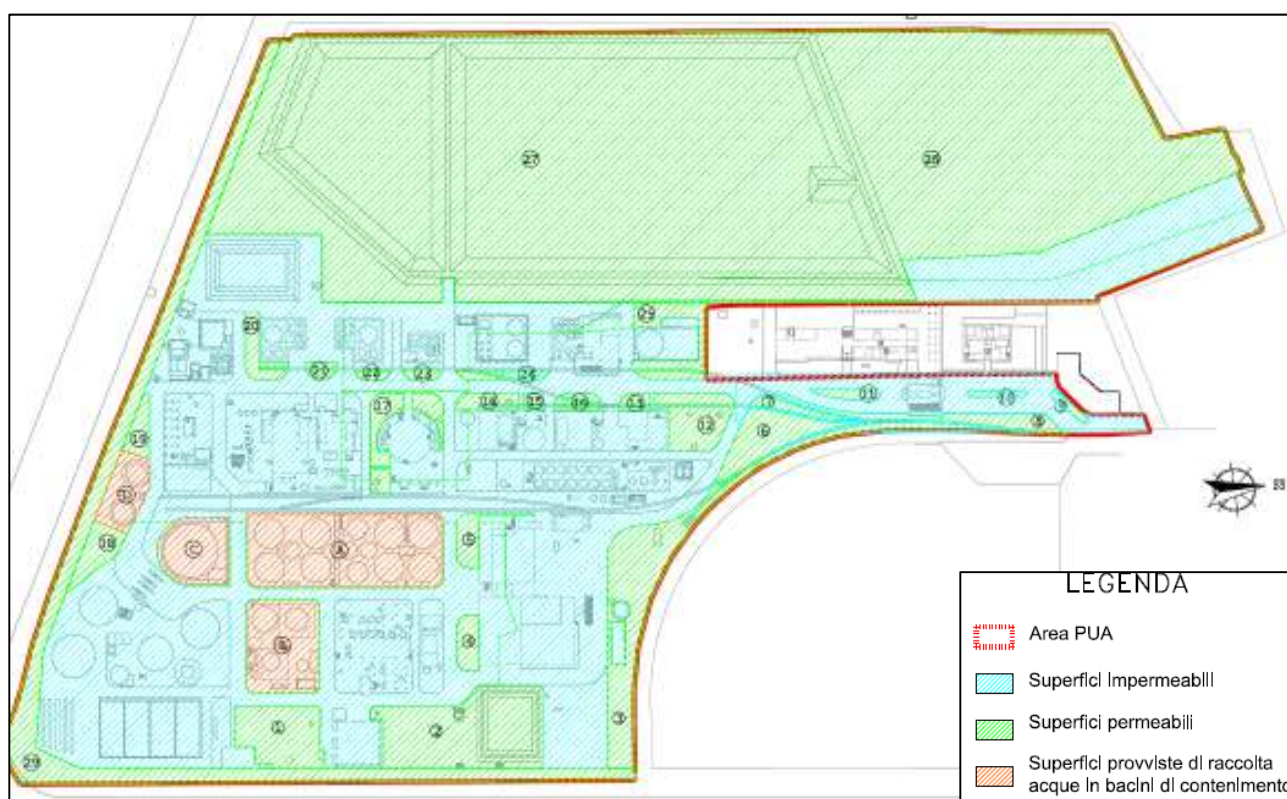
Individuazione superfici permeabili ed impermeabili pre intervento (v. Tav. 1).
